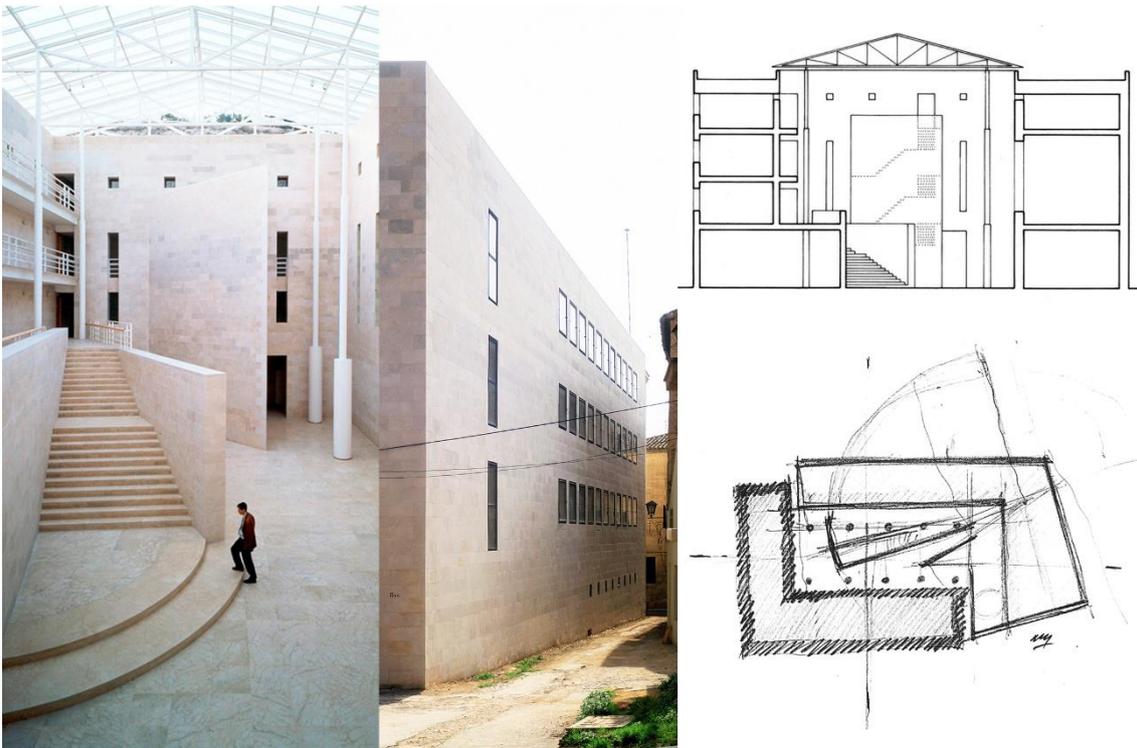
Acceso interior, fachada, sección transversal y esquema conceptual.
